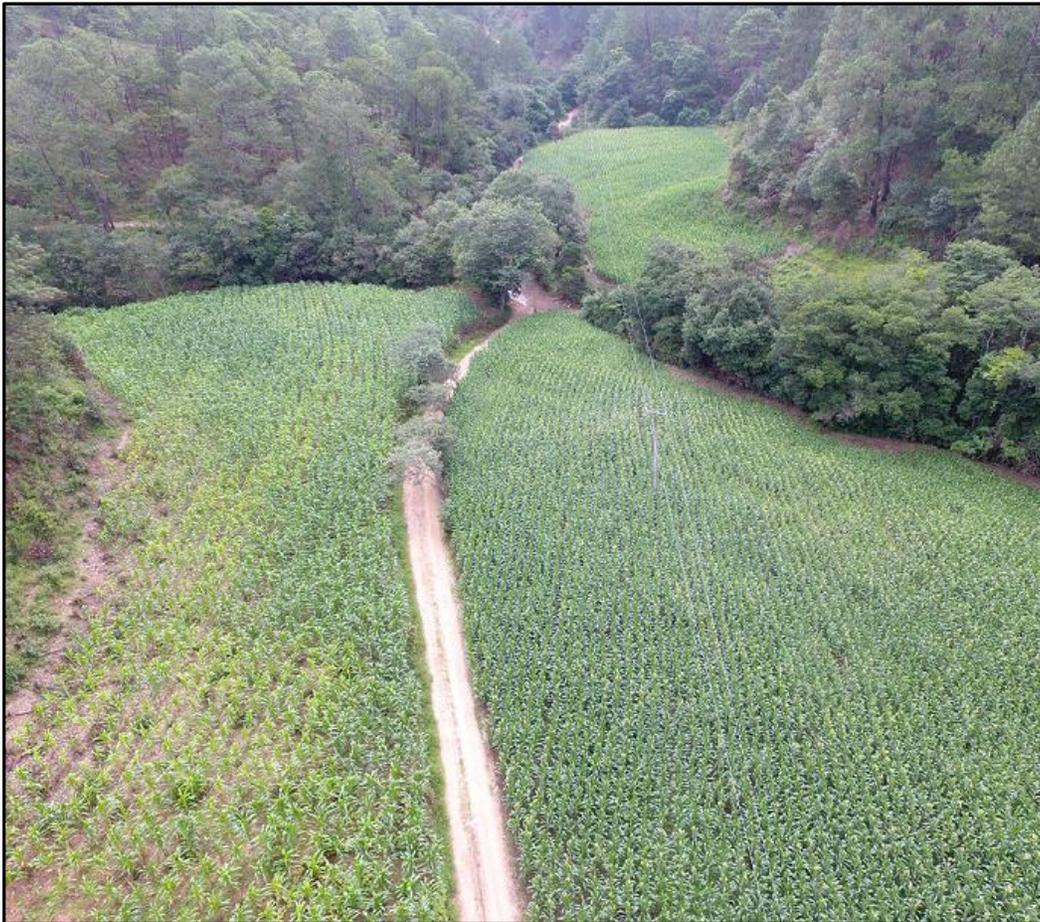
Camino actual de terracería en donde se pretende ejecutar el proyecto.
